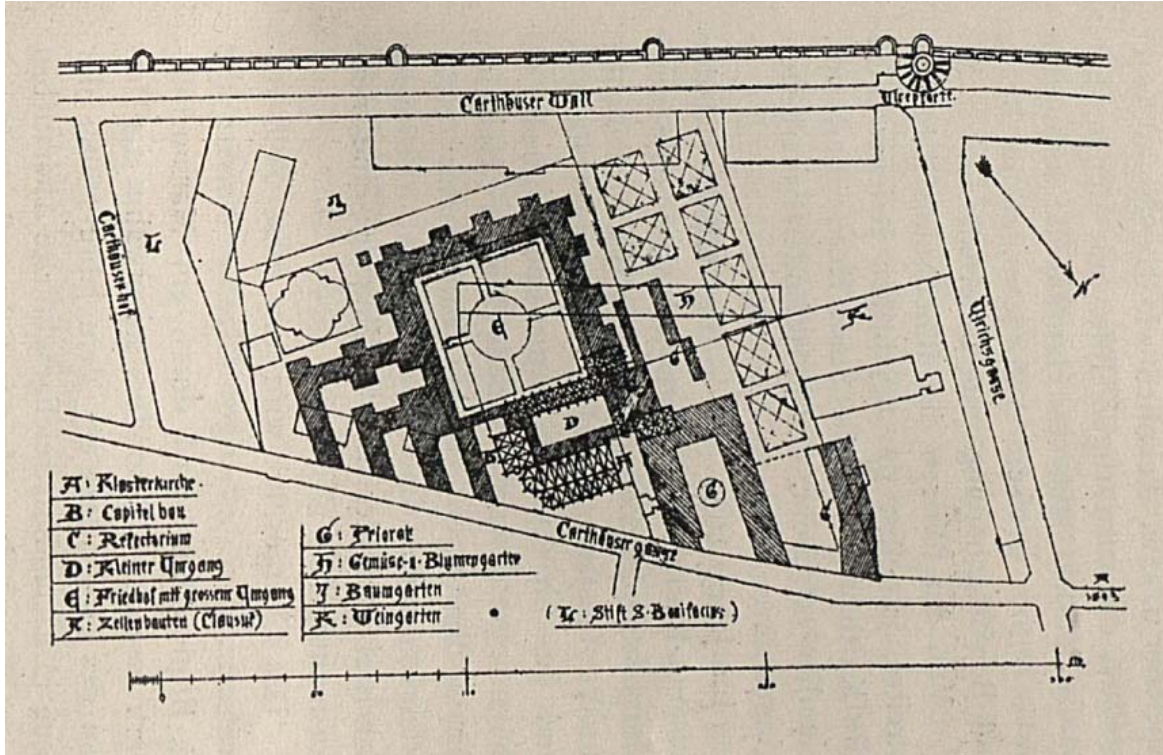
Ludwig Arntz – Grundriss der Klosteranlage der Kartause St. Barbara in Köln
